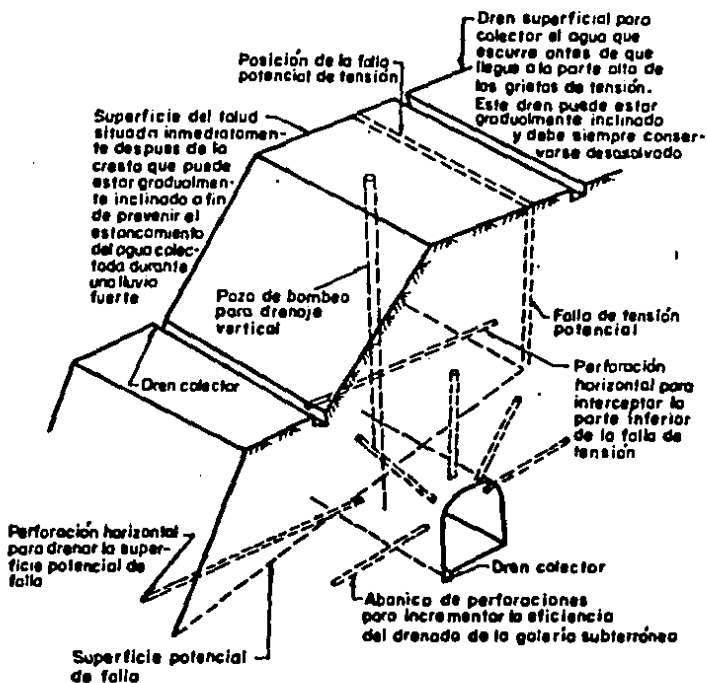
Elementos constitutivos del drenaje en taludes.
